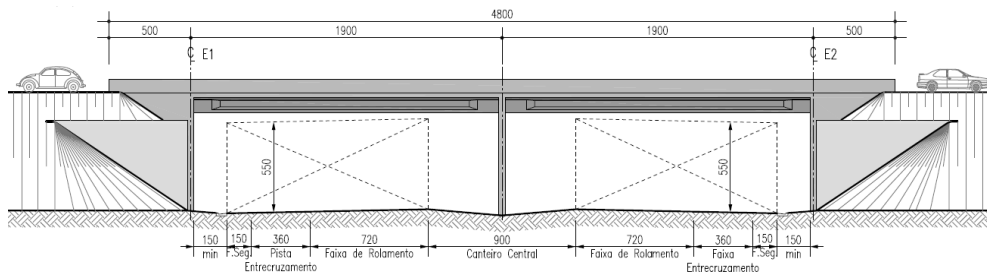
Passagens Inferiores com canteiro central e faixa de entrecruzamento nos dois sentidos. Elevação.
